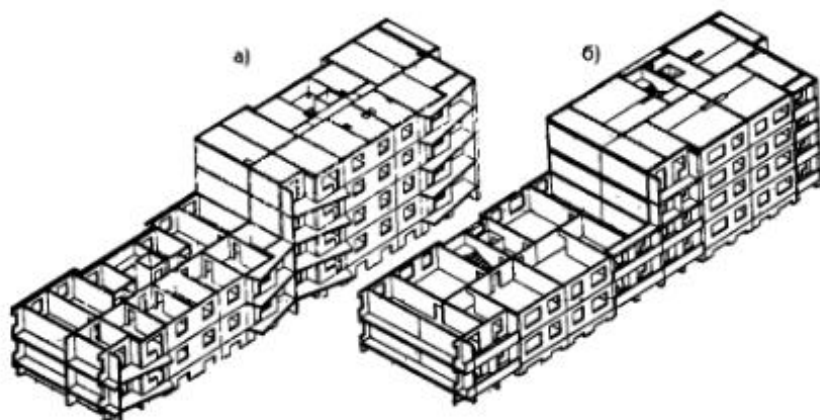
Бескаркасные конструктивные системы панельных зданий массового применения: а - перекрестно - стенная с малым шагом поперечных стен; б - поперечно - стенная со смешанным шагом
